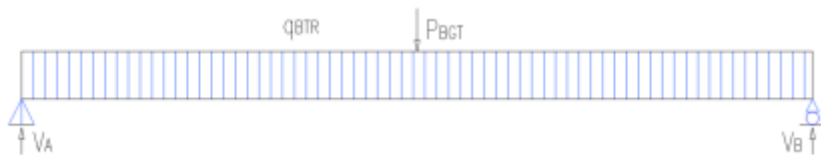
23 Permodelan beban mati girder tengah 21 m
